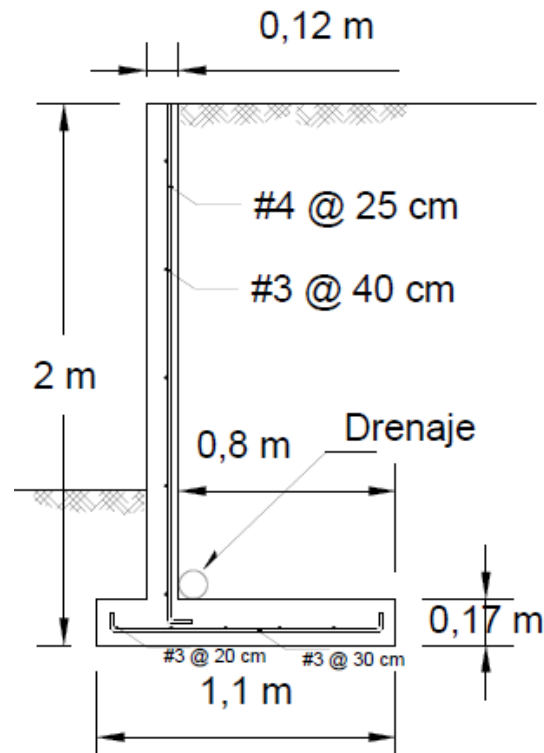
Muro de concreto de 2 metros de altura con un suelo tipo S1
